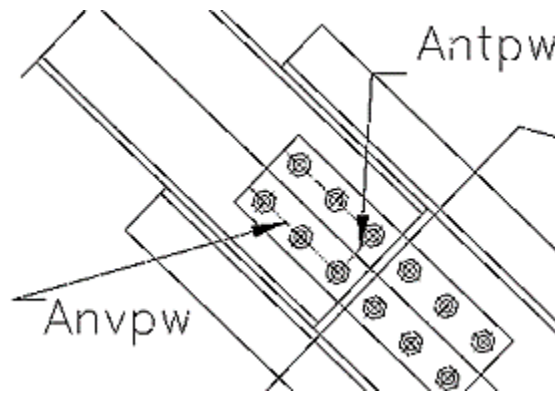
Área gruesa y neta de planchas (Corte y tracción): Fuente: Propia realizado en AUTOCAD.
